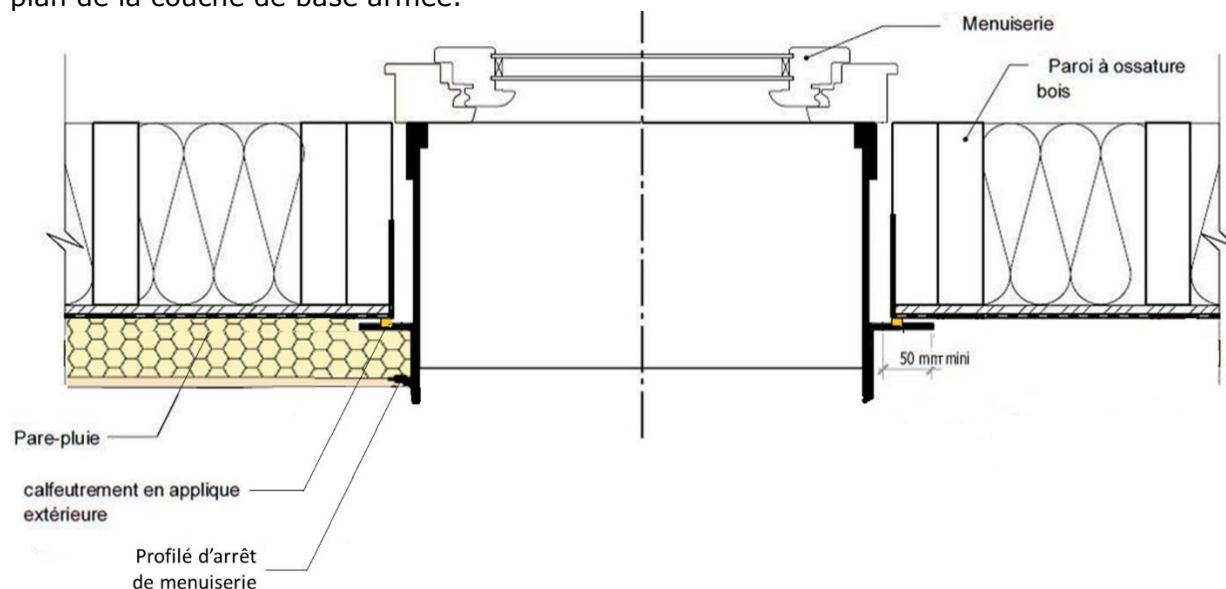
Encadrement de baie rapporté (Ee2) – coupe horizontale
